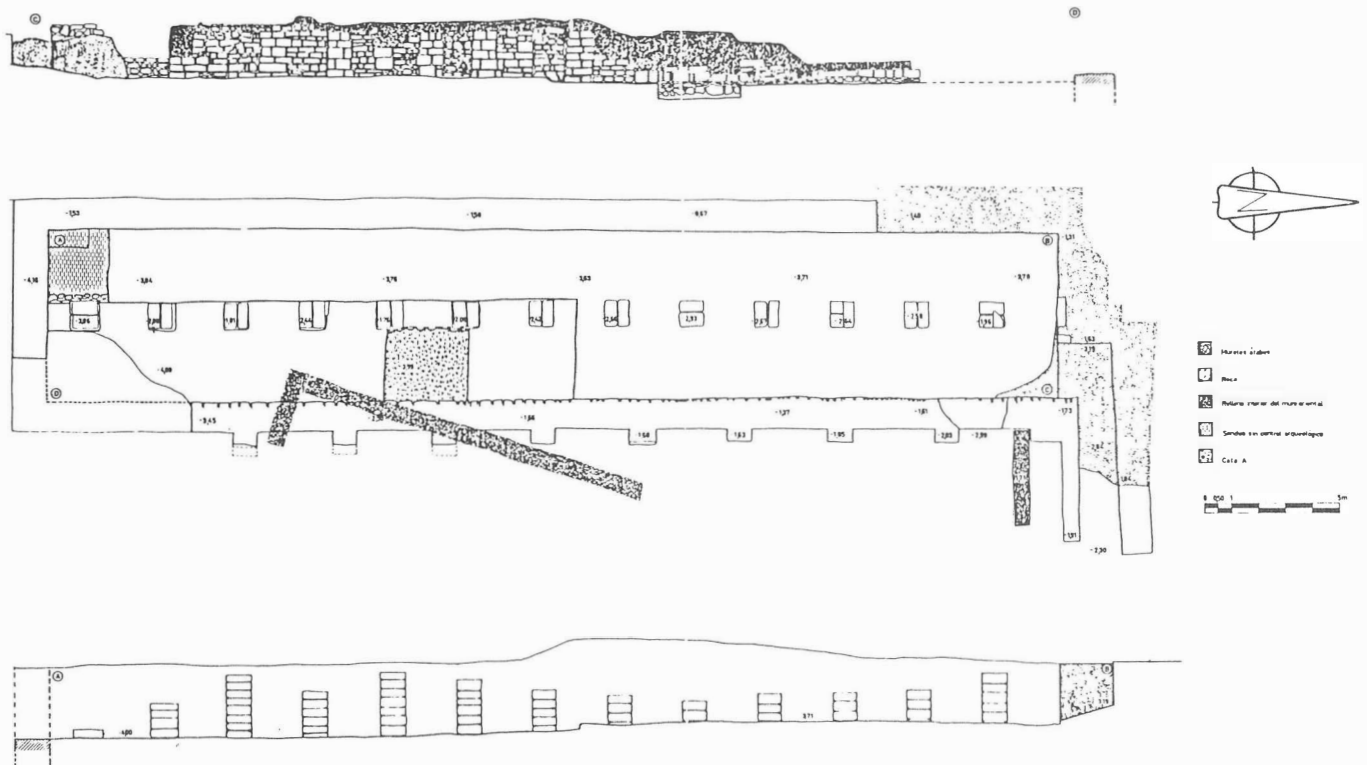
Planta general de la estructura. Alzado del paramento interior del muro oriental y alzado de la hilada de pilares centrales que divide la estructura en dos naves.
